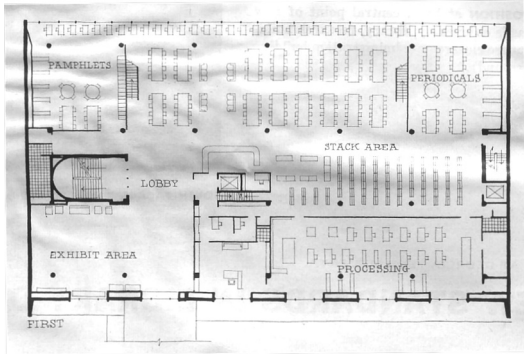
Price-Gilbert-Library des Georgia Institute of Technology in Atlanta, Grundriss des 1. Obergeschosses
